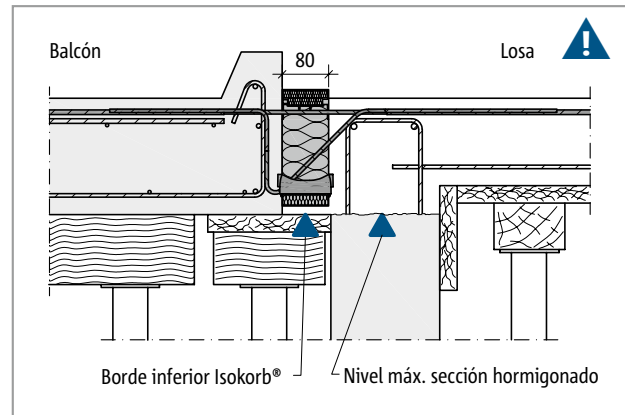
Schöck Isokorb® T tipo K: Balcón íntegramente prefabricado con losa desplazada en altura sobre muro de hormigón armado prefabricado
